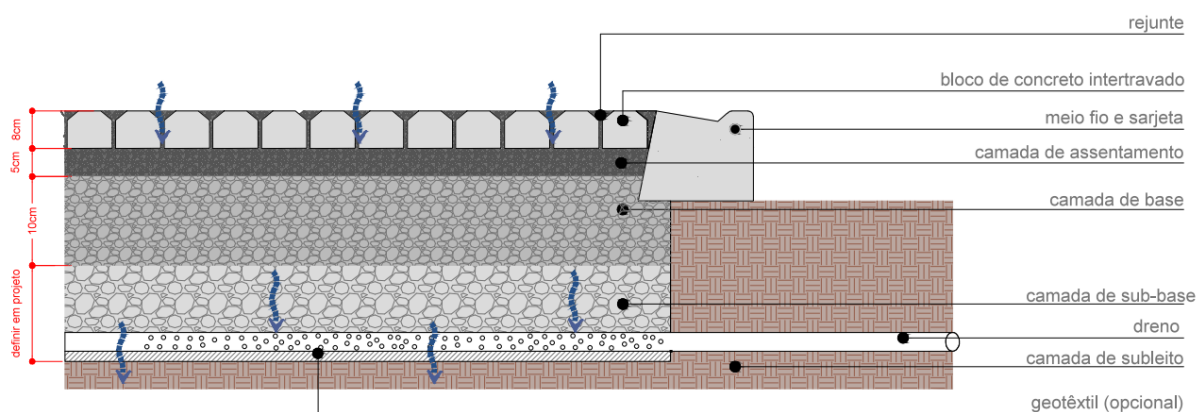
Pavimento intertravado permeável sem infiltração no solo
